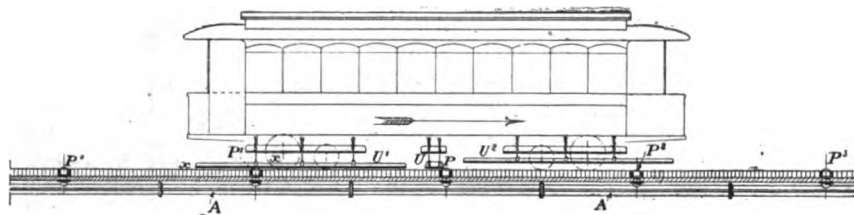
Coupe longitudinale d'une voie de tramway, système Barbillion et Griffisch.
